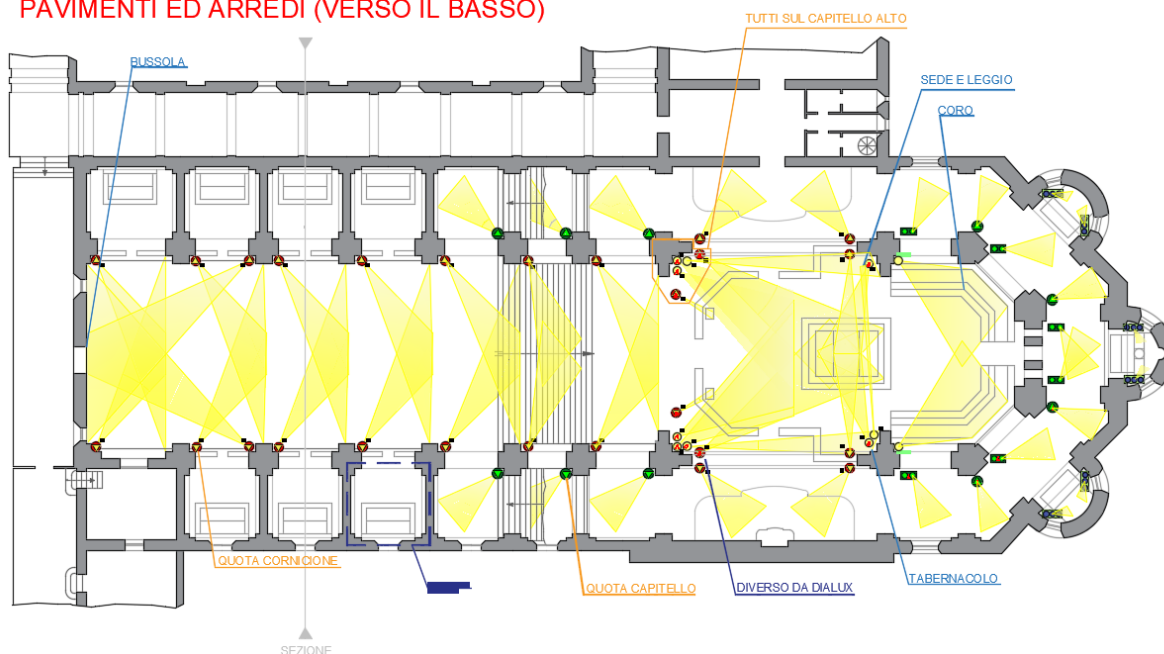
pianta con i fasci di luce per i pavimenti, le scale, coro, altare ed ambone
